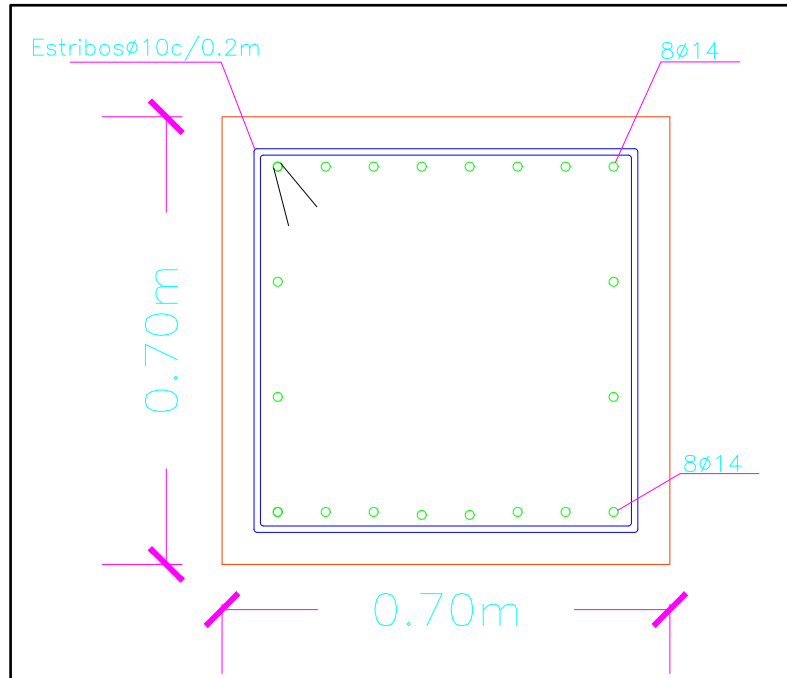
Dimensionamiento de la viga cabezal para el muelle secundario. Fuente: Autores
